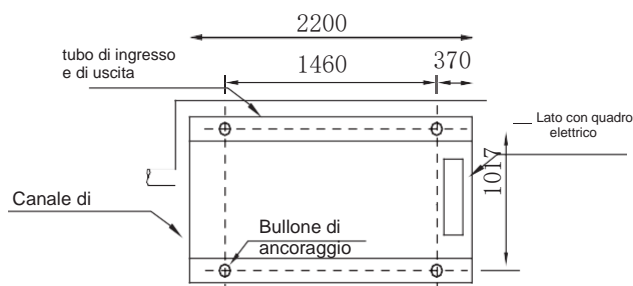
Vista dall'alto di un diagramma schematico delle dimensioni dell'installazione SCV-900EBH
